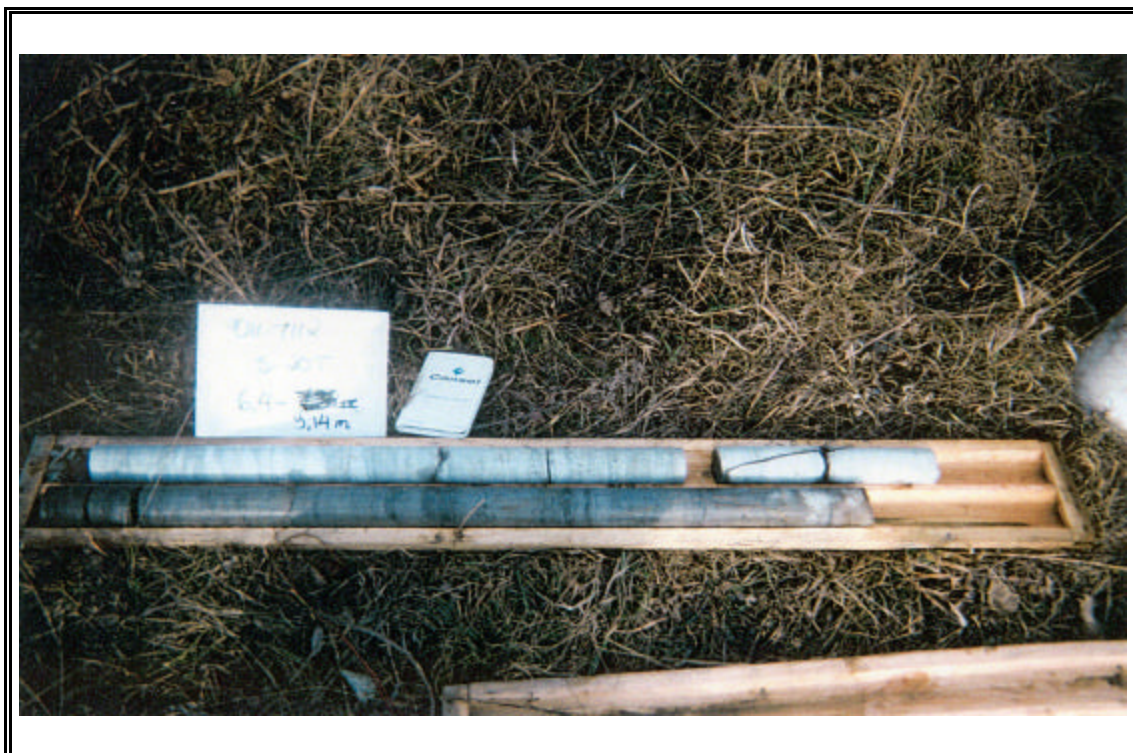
Roc carotté au site de forage S-20, profondeur de 6,40 m à 9,14 m.
